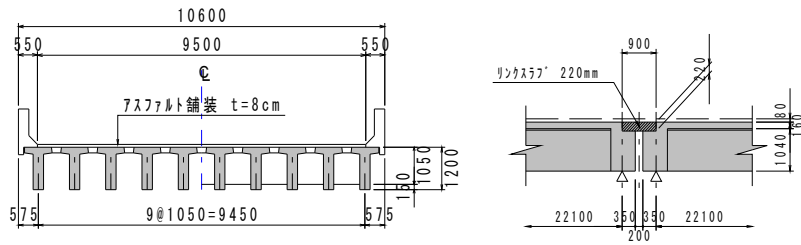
6 径間連結プレテンション T 桁橋 (試設計モデル 1)
